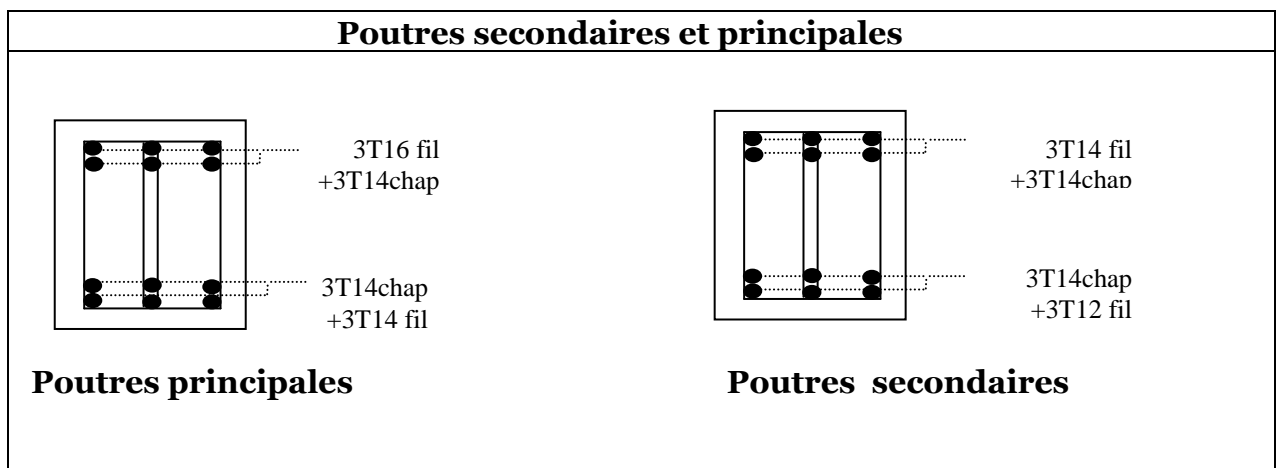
Dessin de ferrailage des sections des poutres principales et secondaires.
